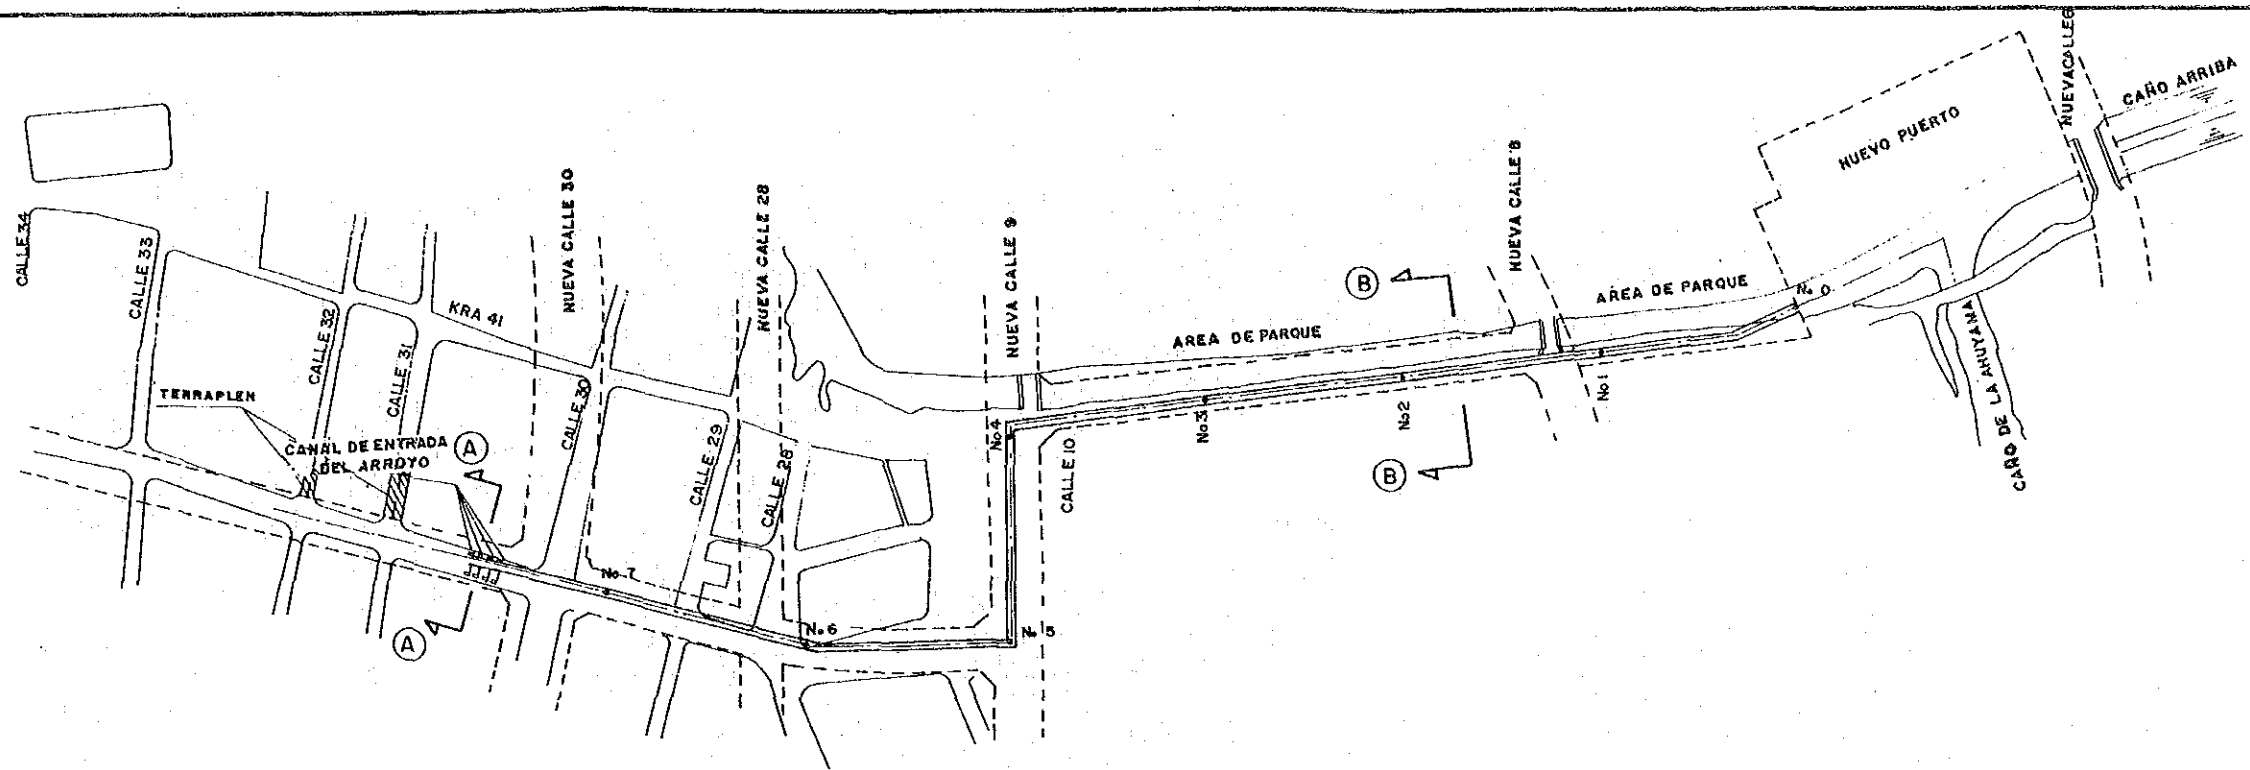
DRENAJE PRINCIPAL NO. 1
